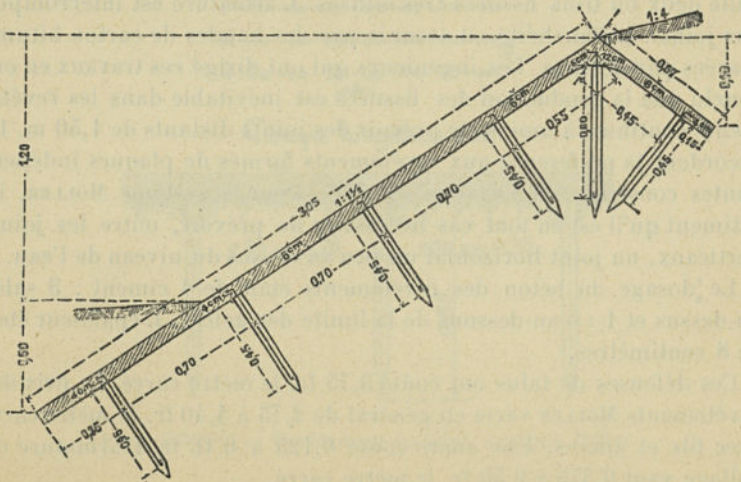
Revêtement au Wikerstrand à Kiel. Coupe transversale.
